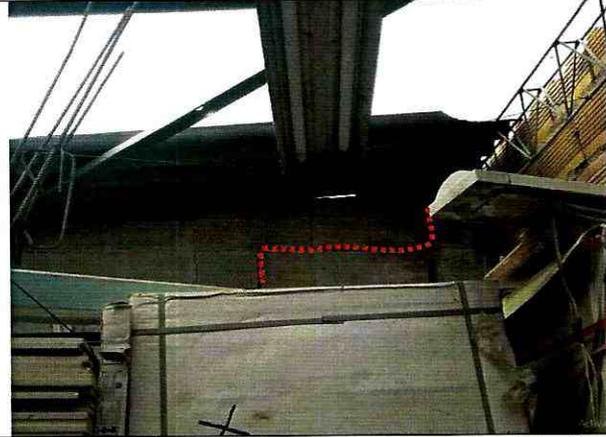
Vista de las fisuras presentes en muros divisorios y de fachada en el predio de la Calle 163 No 17-24
